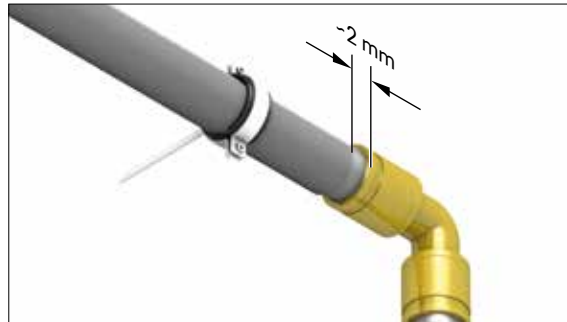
Interruzione della canalina semicilindrica ad incastro circa 2 mm prima del collegamento con manicotto autobloccante
